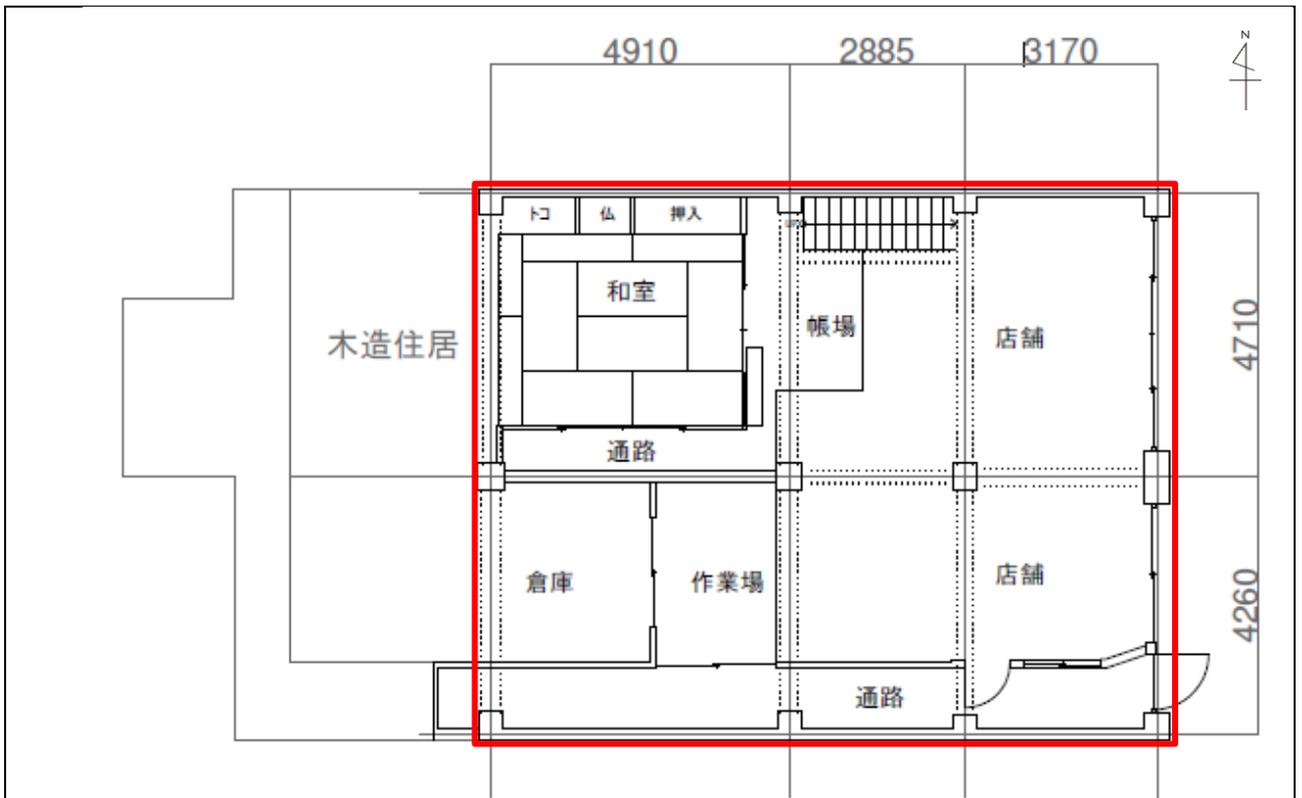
1 階平面図 (2025 年 1 月実測)
